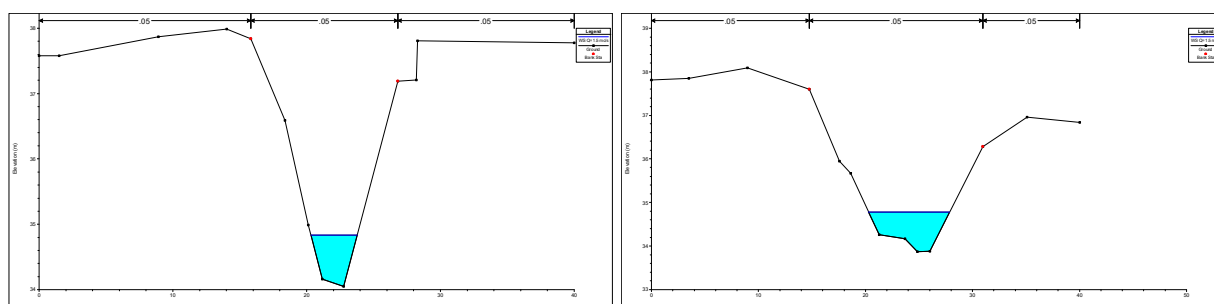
Sezione 10 (a sinistra) e sezione 9 (a destra), stato di progetto
